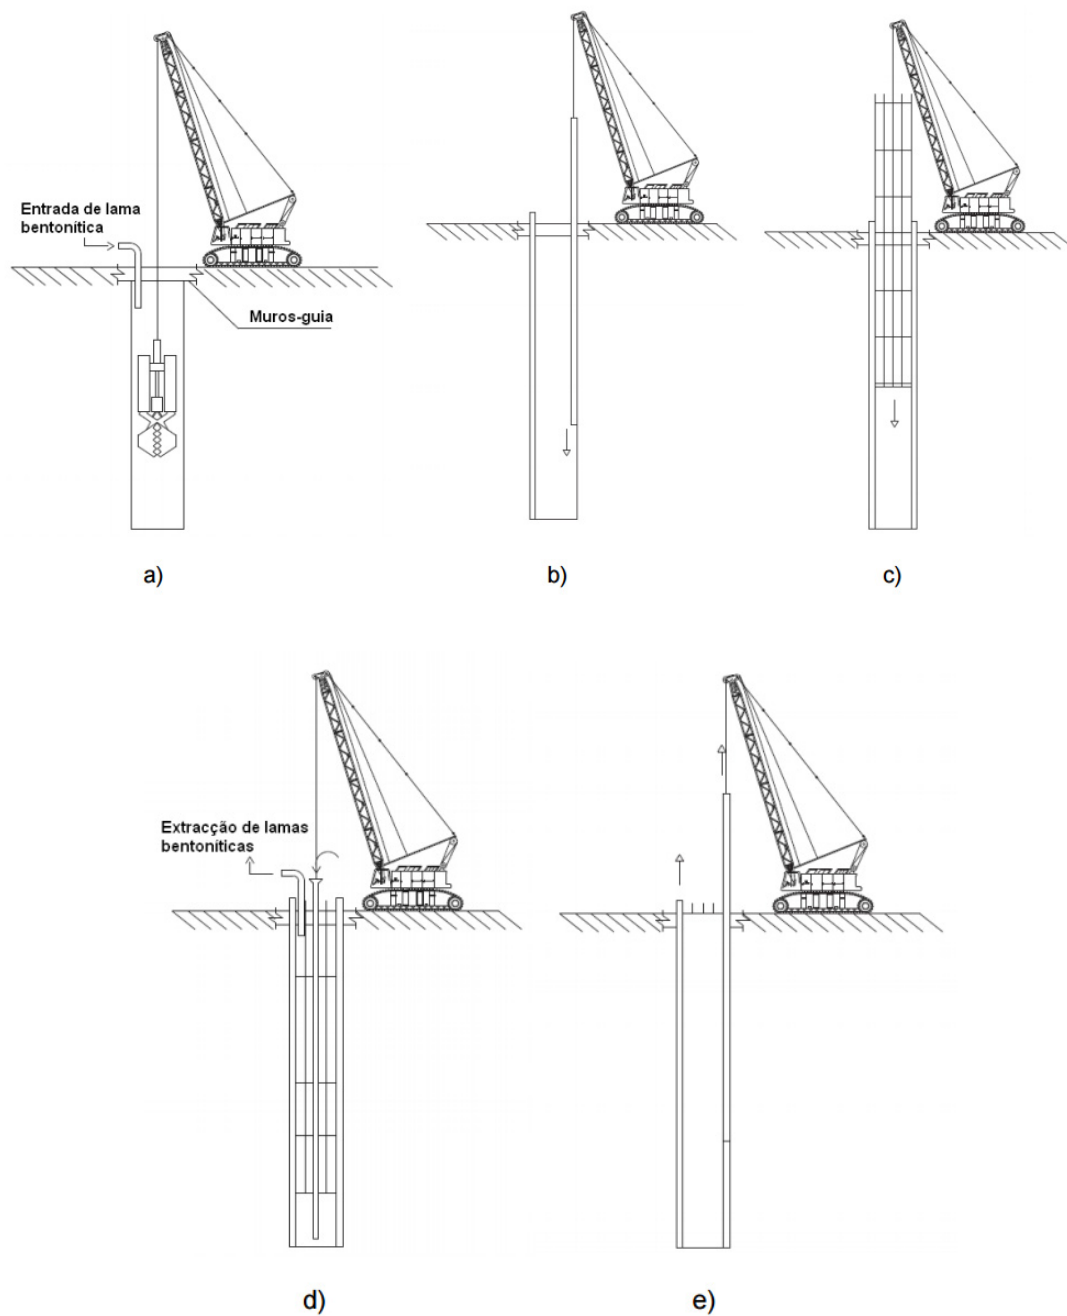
Fases de execução de uma parede moldada *in situ*: a) escavação; b) colocação de tubo-junta; c) colocação da armadura; d) betonagem; e) extração de tubo-junta (Fonte: Pinto, 2008).
